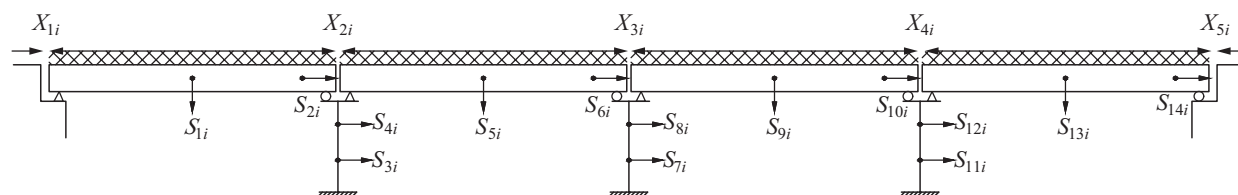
Расчетная схема железнодорожного моста при расчетах на продольные сейсмические воздействия
